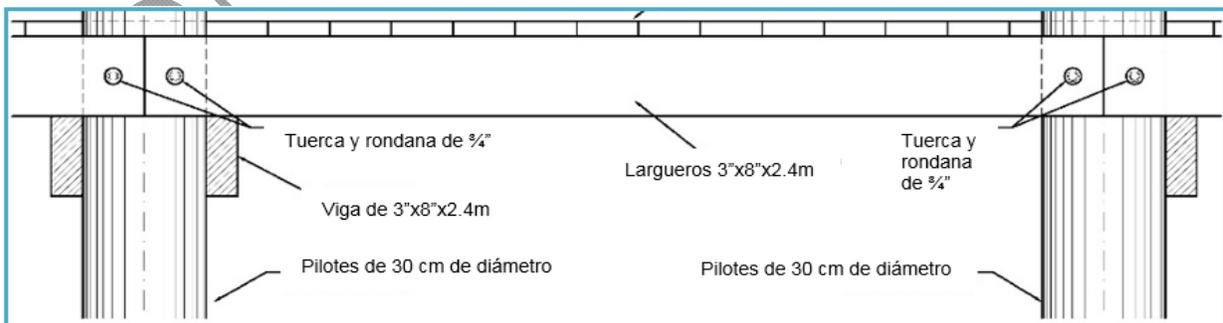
Detalle longitudinal de la estructura de conexión.
